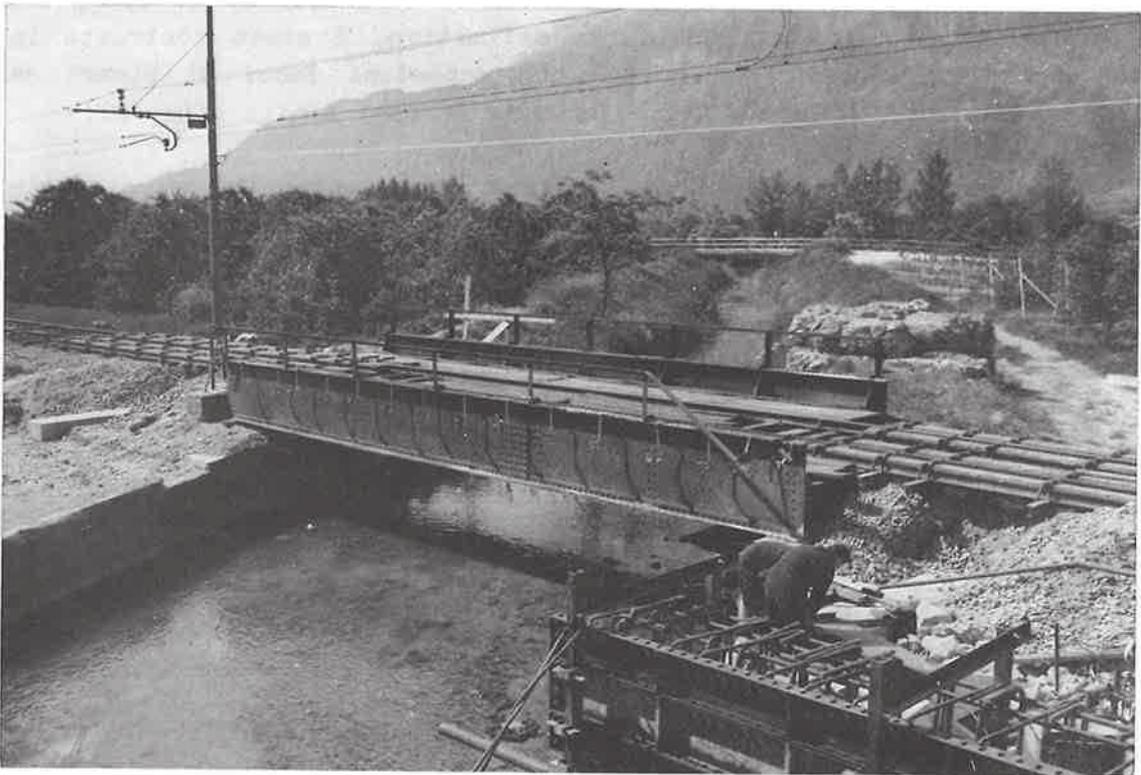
Il vecchio ponte in acciaio. E' visibile il fascio di binari in corrispondenza dello scavo appena iniziato per la costruzione del traverso di appoggio del manufatto definitivo.
